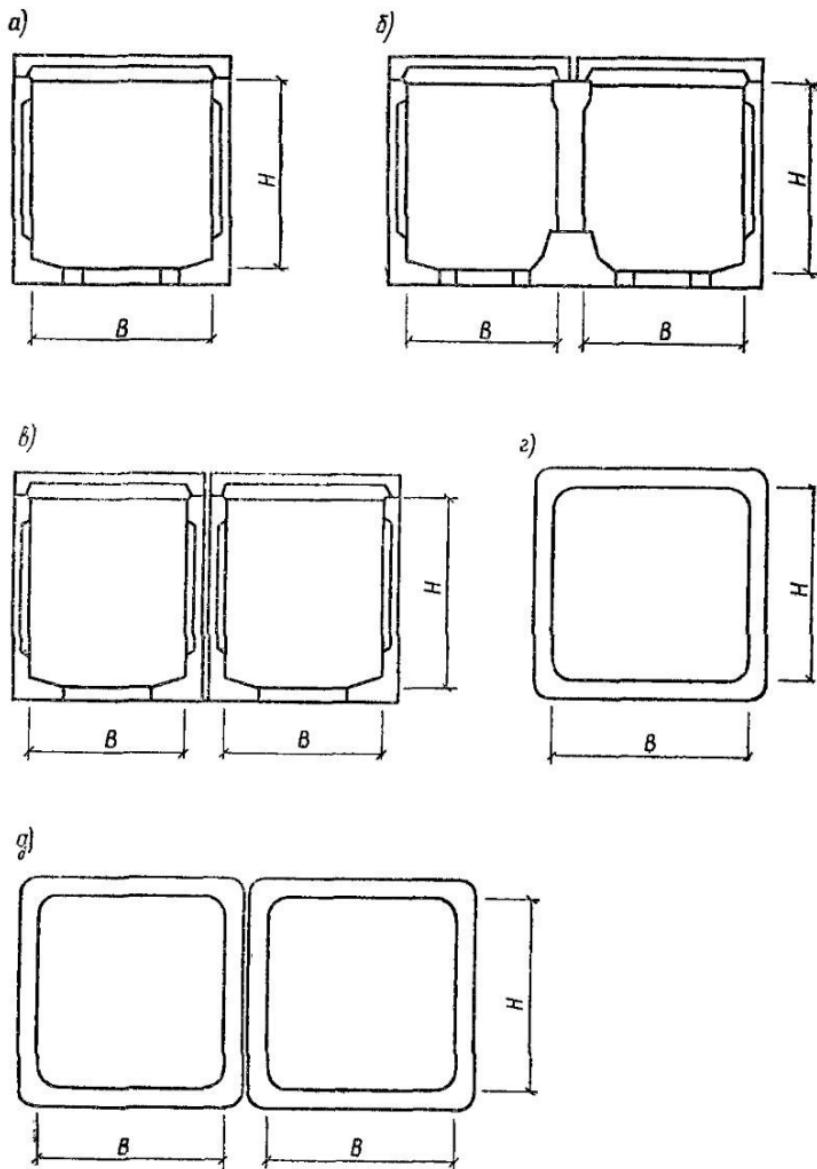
Сборные железобетонные конструкции тоннелей
